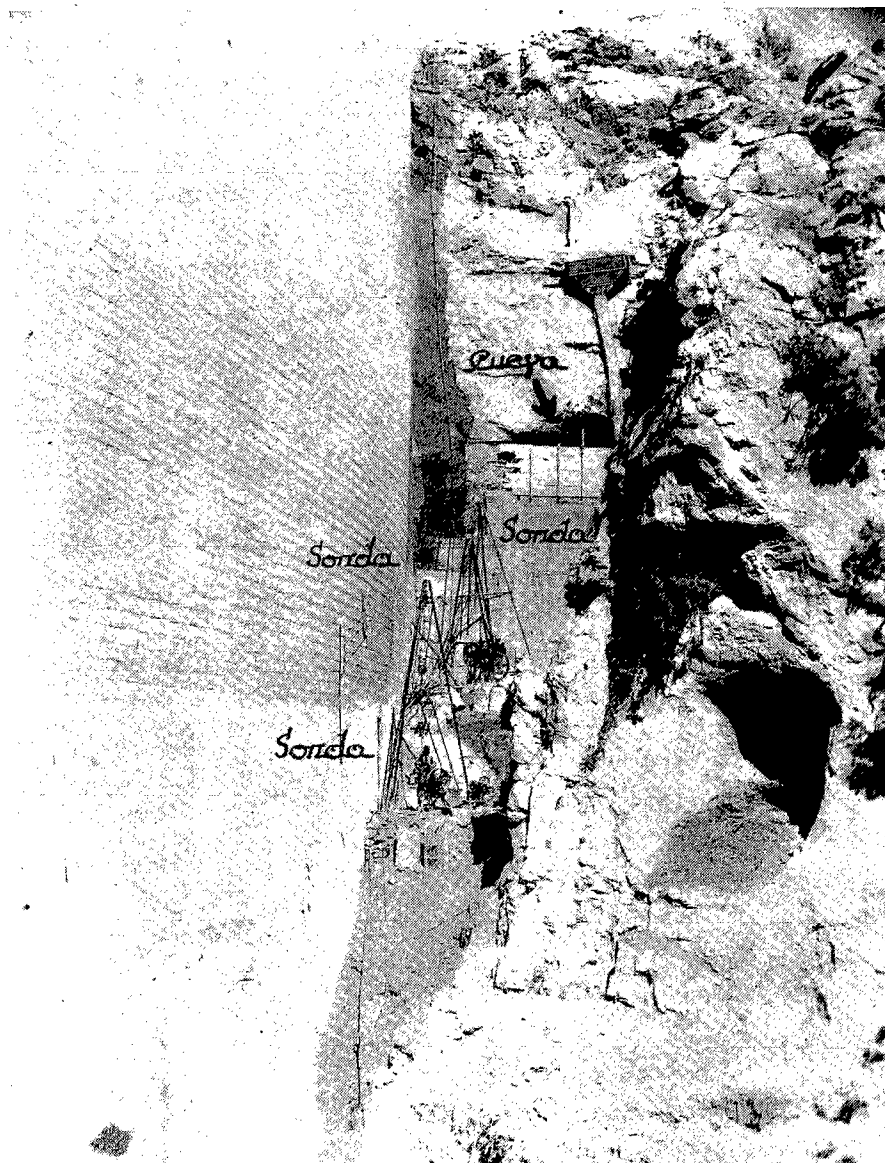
^a — Impermeabilización de la ladera derecha y hormigonado de la cueva.
